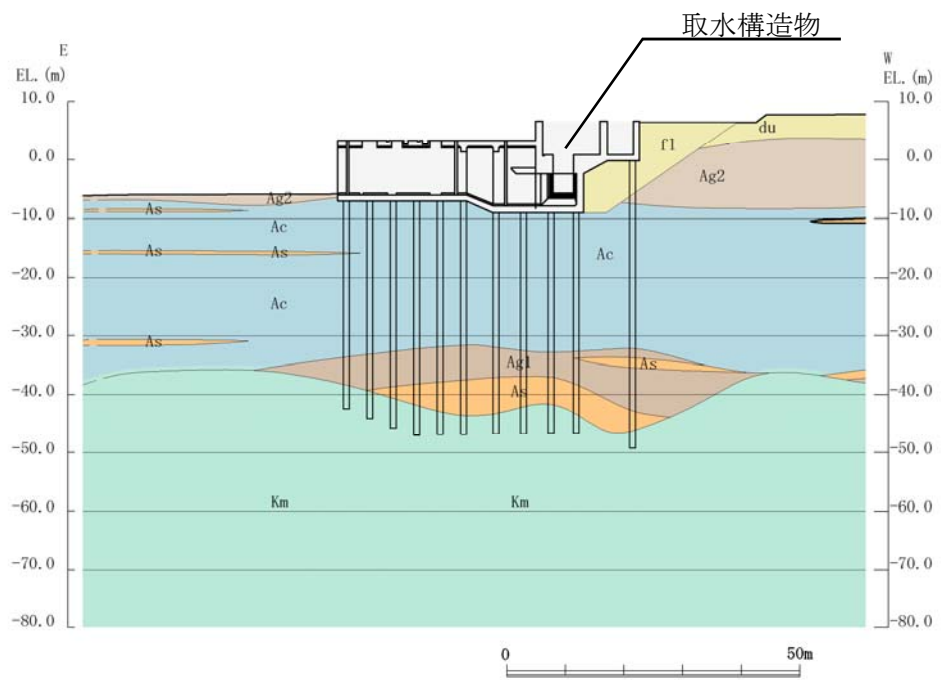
(3) 地質断面図 (⑥-⑥断面)
